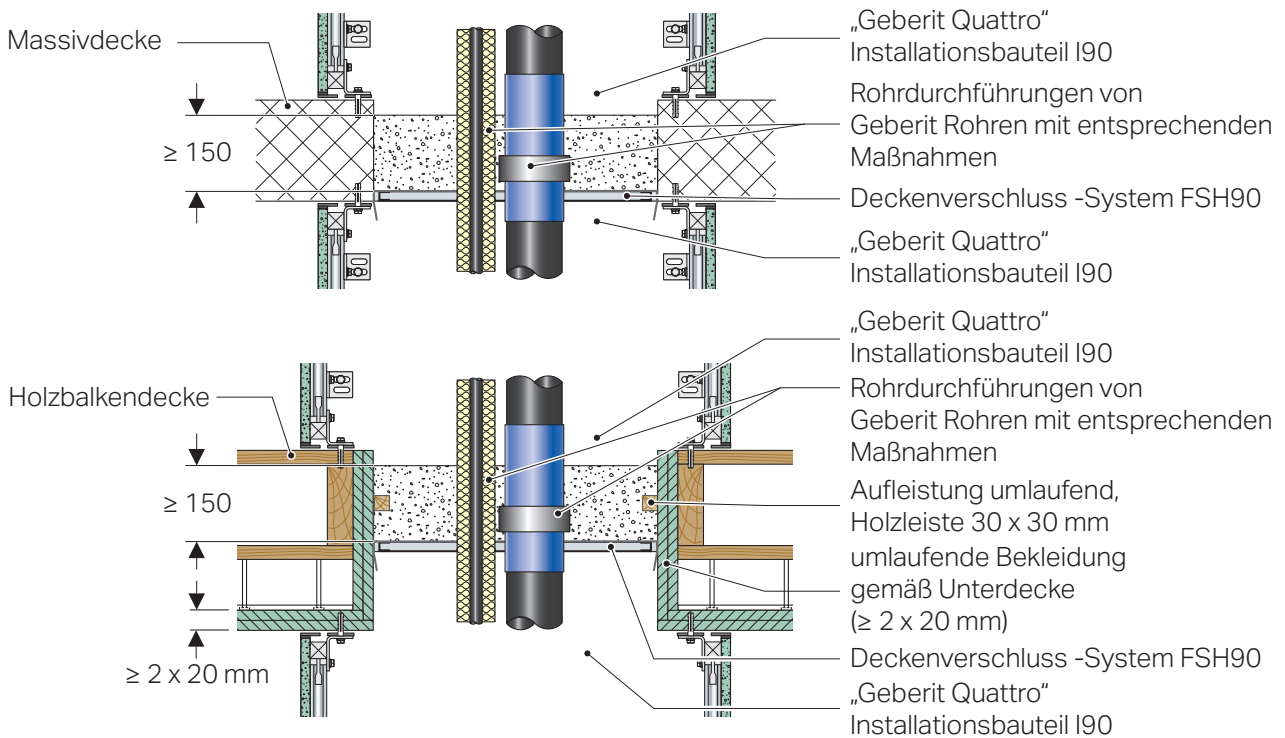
Deckendurchführungen im Geberit Quattro Installationsschacht durch Massiv- und Holzdecken
